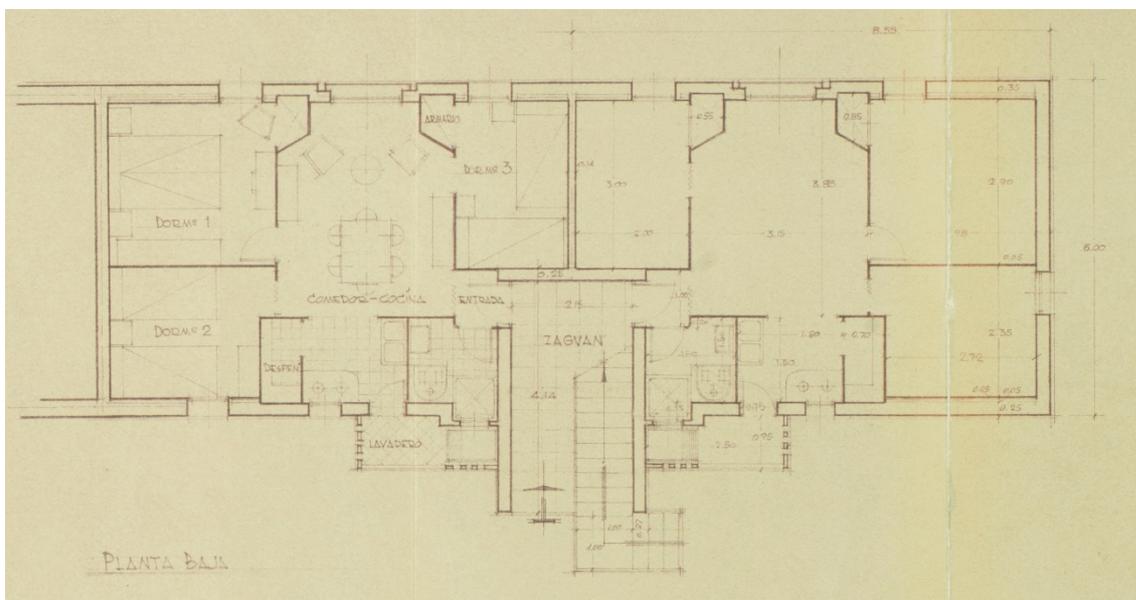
Planta baja bloque lineal. ICAS-SAHP, Archivo Municipal de Sevilla, Obras de Particulares.
